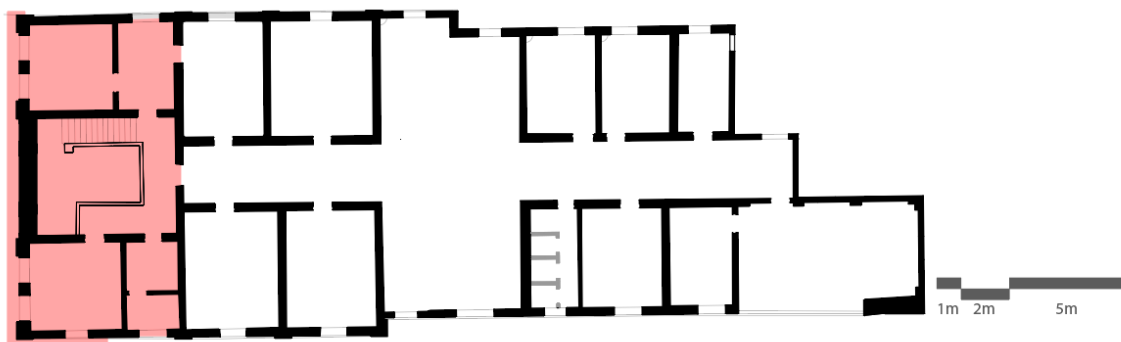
Planta esquemática do 1º pavimento com marcação em rosa da porção utilizada para o presente estudo.
